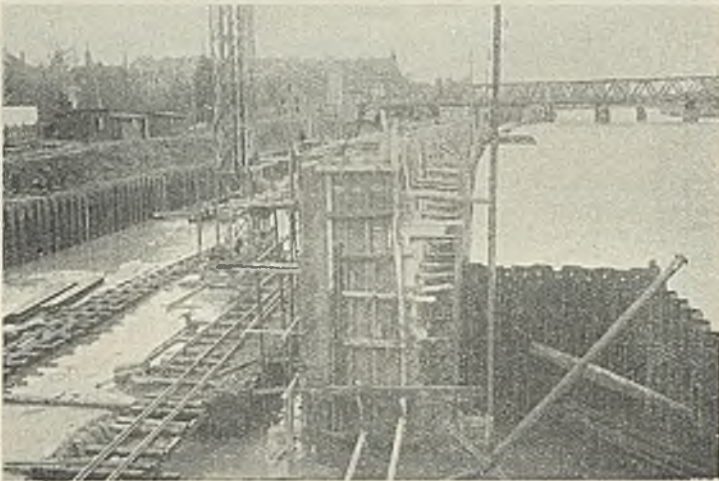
Schleppzugschleuse Hameln. Schleusenbaustelle mit neuer Straßenbrücke.
